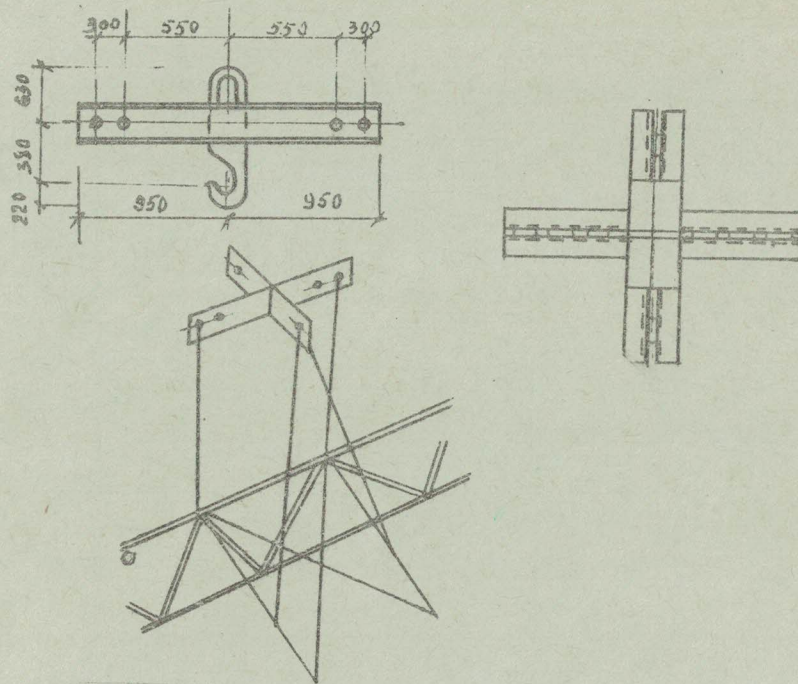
Универсальная траверса для подъема ферм со связями
